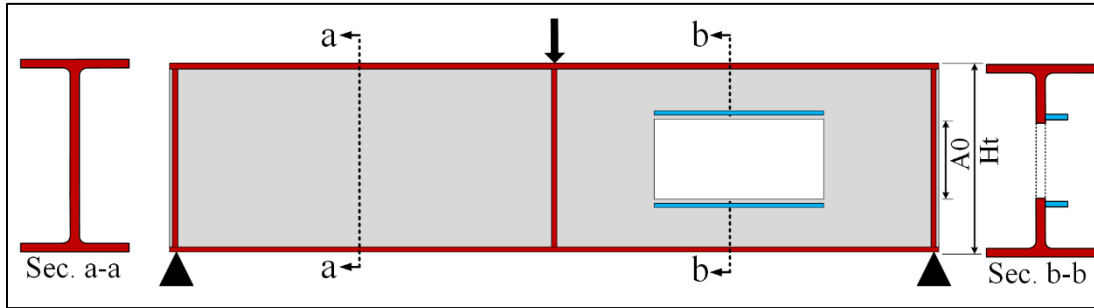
Exemple d'une poutre en acier munie d'ouverture dans l'âme avec raidisseur
